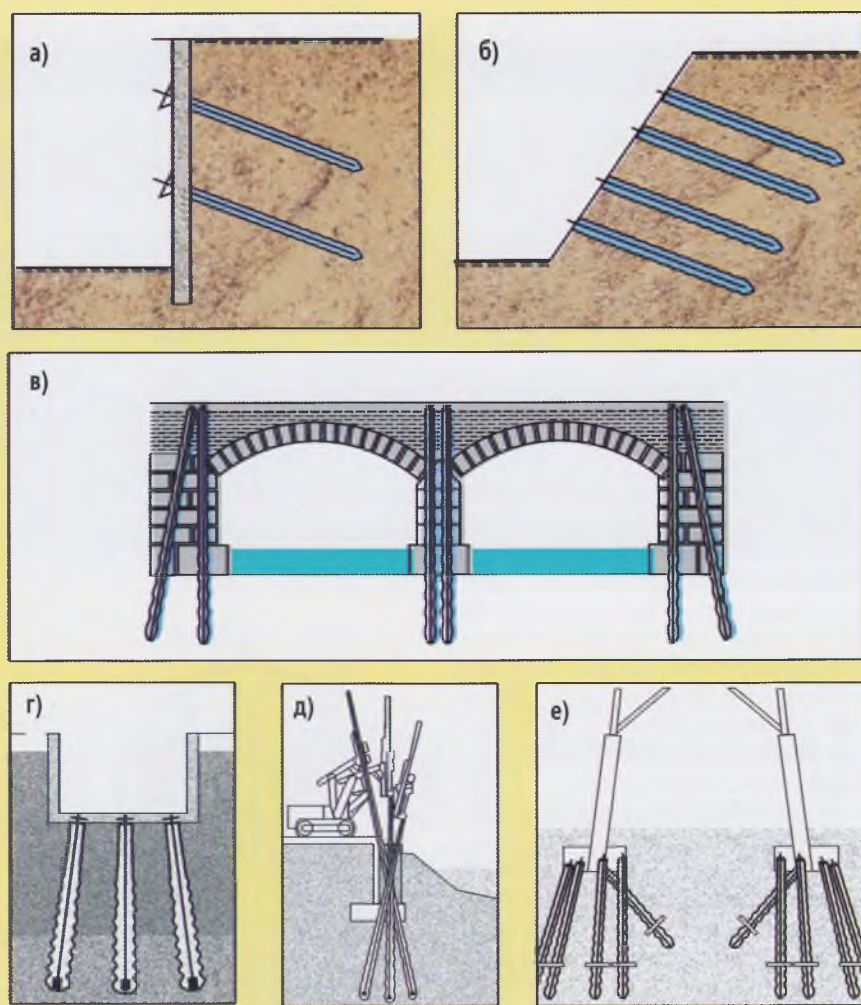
Анкерные сваи «Титан» используются в качестве: а) пассивных анкеров для крепления подпорных стен и ограждений строительных котлованов; б) для укрепления грунтовых стен и оползневых склонов откосов в качестве нагельных элементов; в) укрепления конструкций; г) предохранения от всплытия; д) укрепления фундаментов; е) свай, работающих на выдергивающую нагрузку
